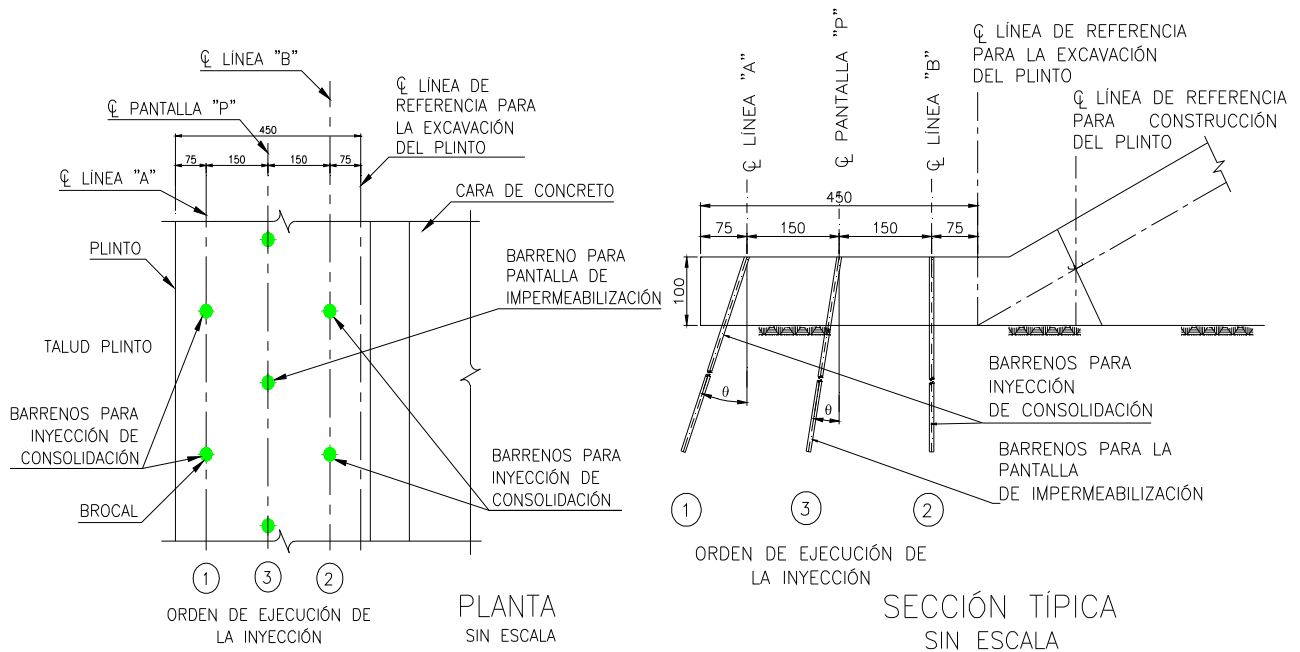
Planta y sección del Plinto y distribución de los barrenos de inyección en el tramo P9-P10.
